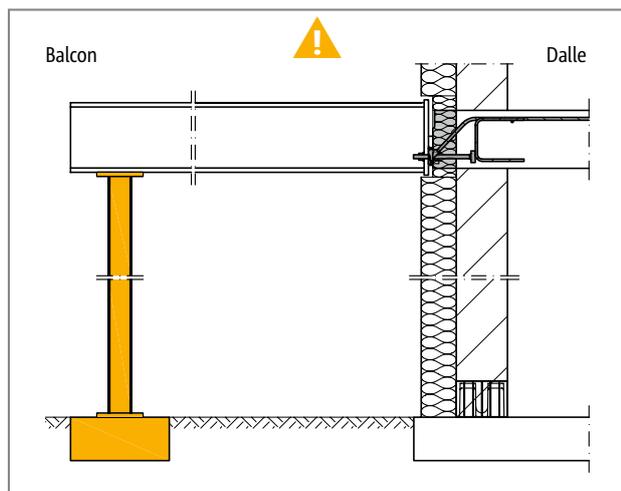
Schöck Isokorb® T type SQ : soutien continu requis
